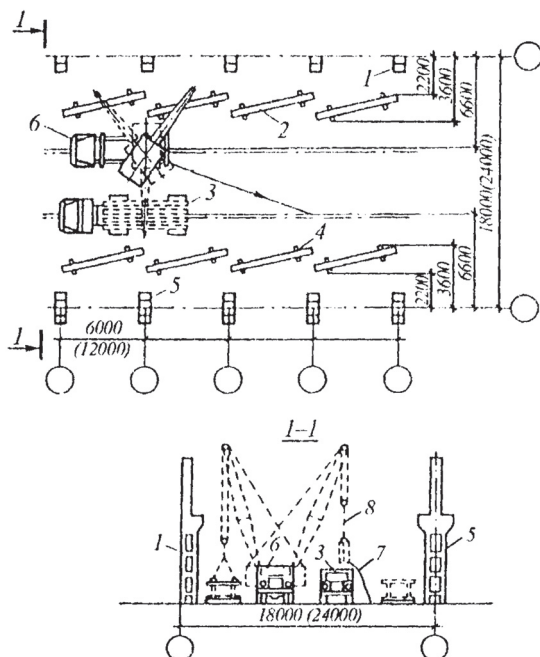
Схема выгрузки и раскладки подкрановых балок пролетом 6 и 12 м:
